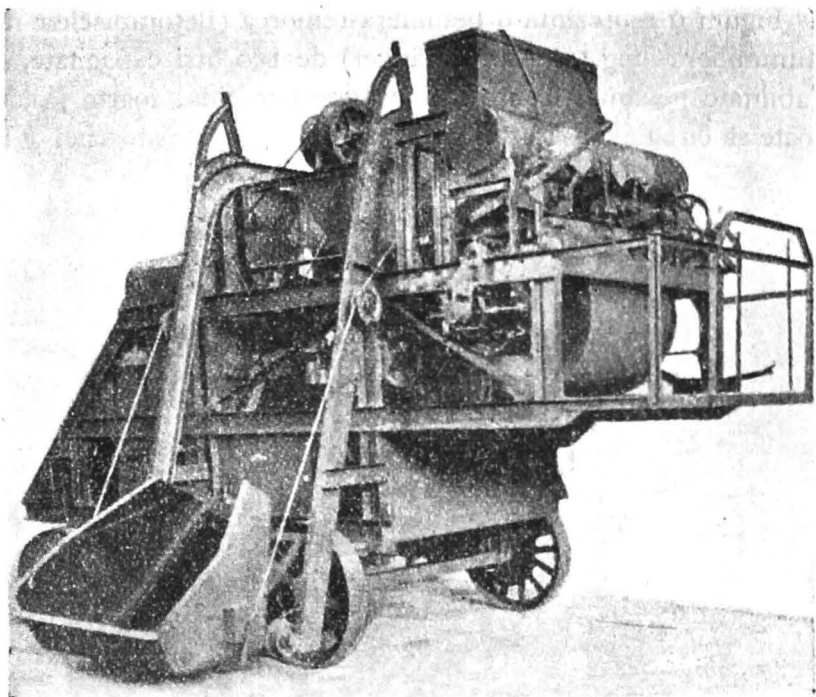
Betonieră transportabilă cu elevator lateral.
